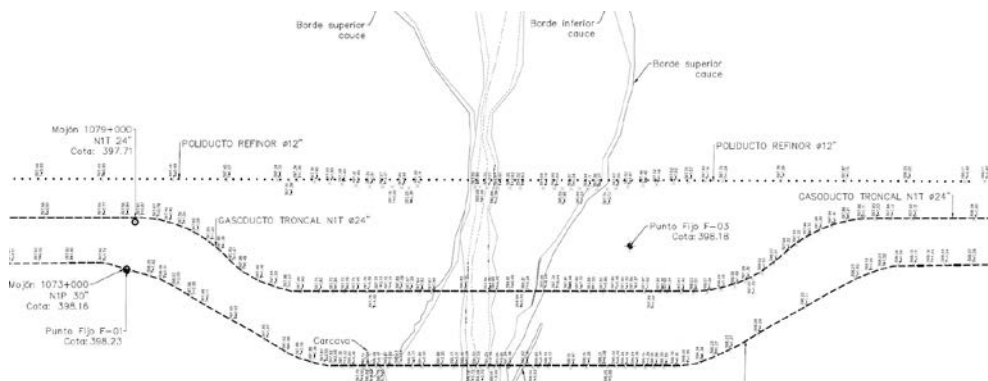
Plano de planta de los puntos de medición de tapadas verticales
